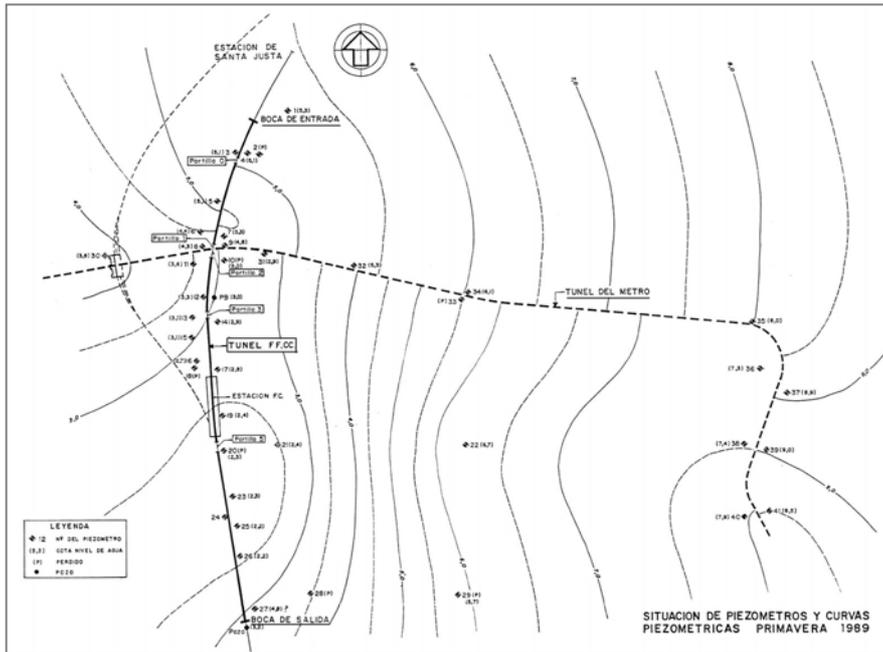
Planta de los túneles del ferrocarril y del metro
